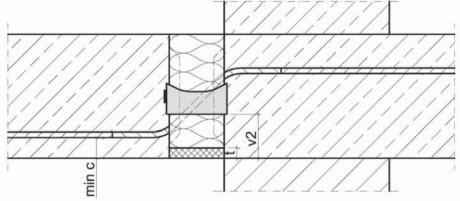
Schöck Isokorb® Typ Q (Ausführungsvariante B) gem. Abschnitt 3.1.2
